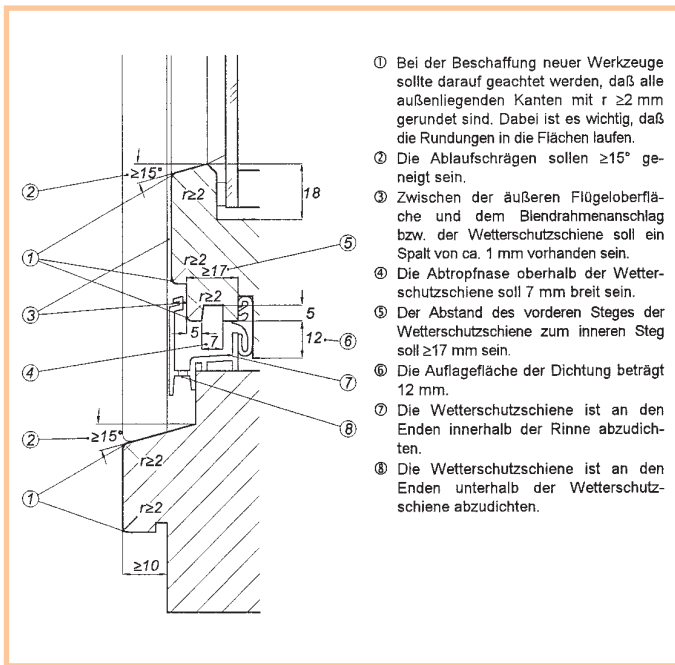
Grundlegende Details zur Wasserabführung aus der Konstruktion
